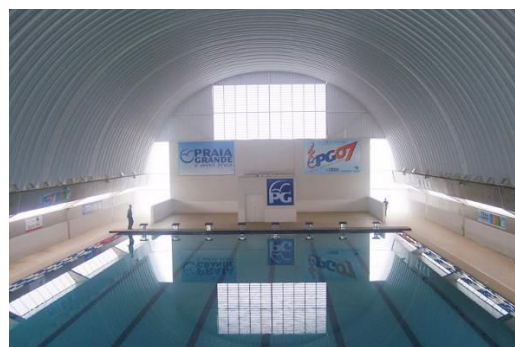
Estrutura com telha metálica autoportante. Fonte: Açoport.
